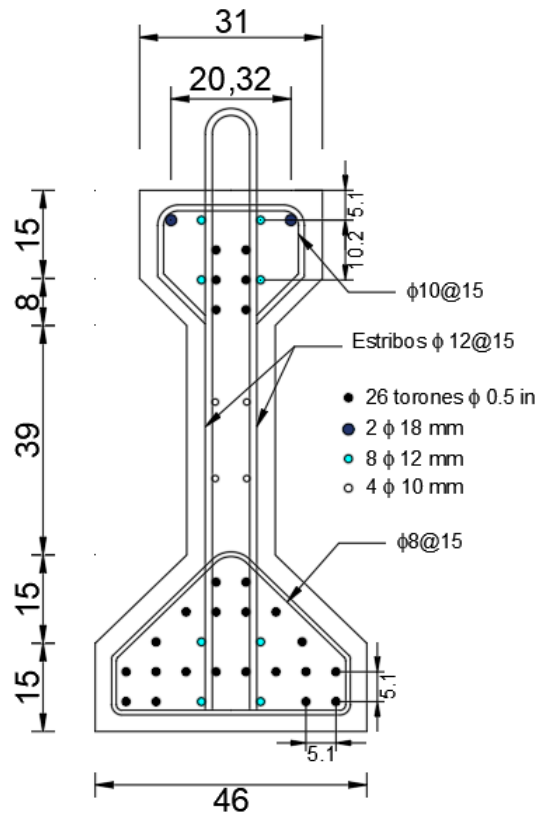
Sección transversal viga pretensada (dimensiones en cm).
